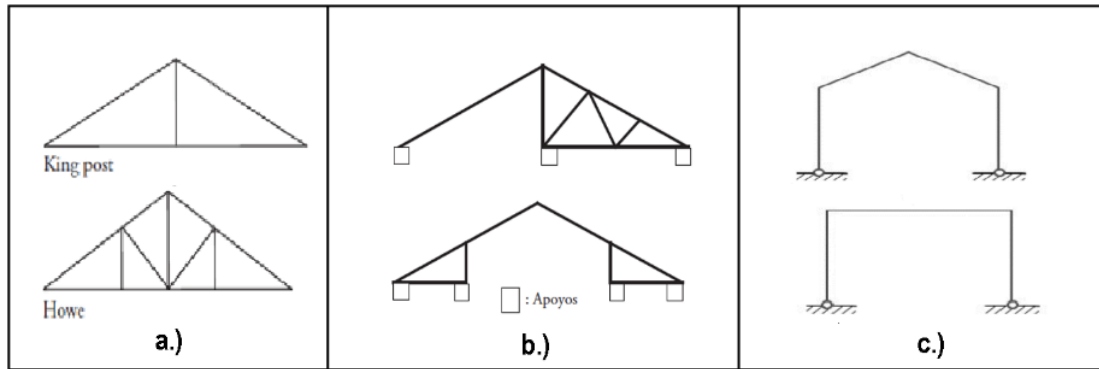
Armaduras tipo cerchas; b.) Tijerales; c.) Marcos con cubierta. Solminihac (2011)
